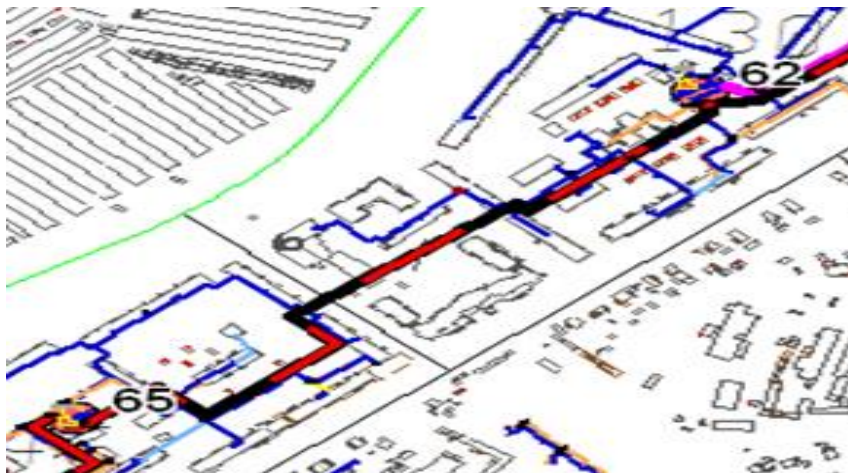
Схема прокладки трубопровода между котельными №62 и №65
